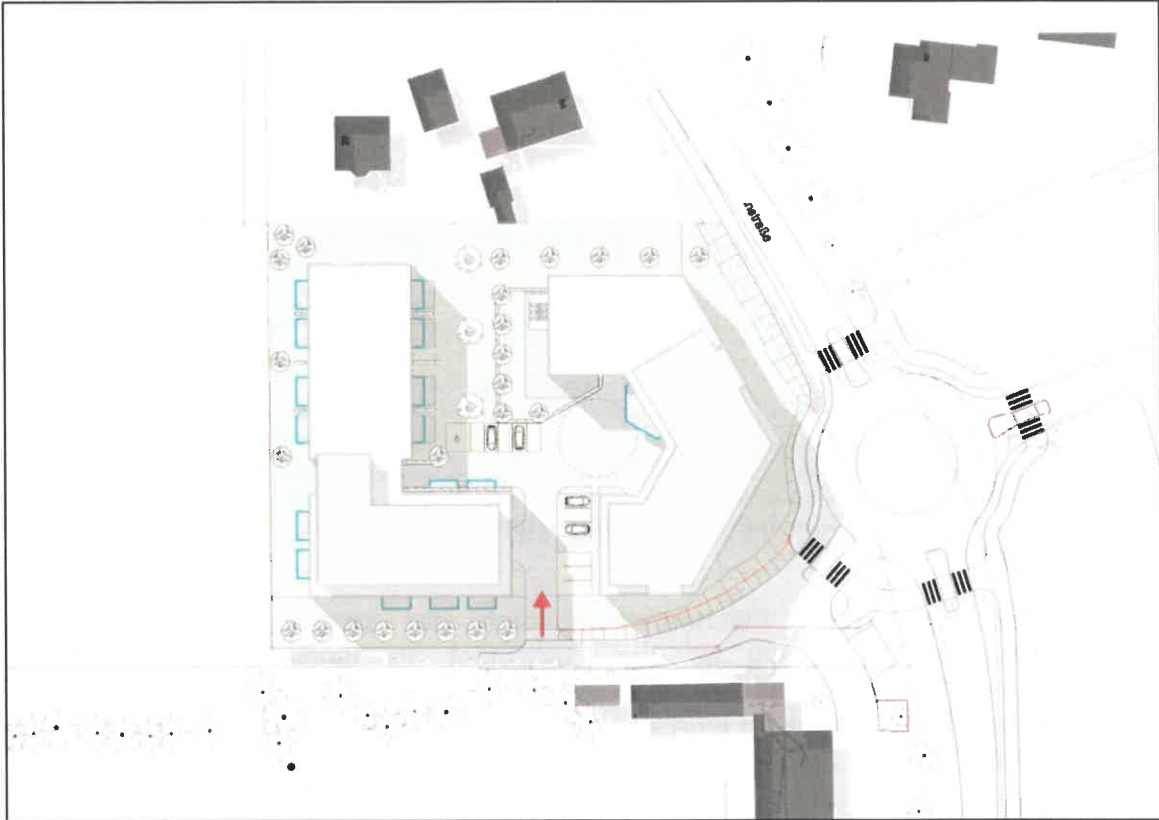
Lageplan mit vorgesehenem Kreisverkehr, unmaßstäblich
